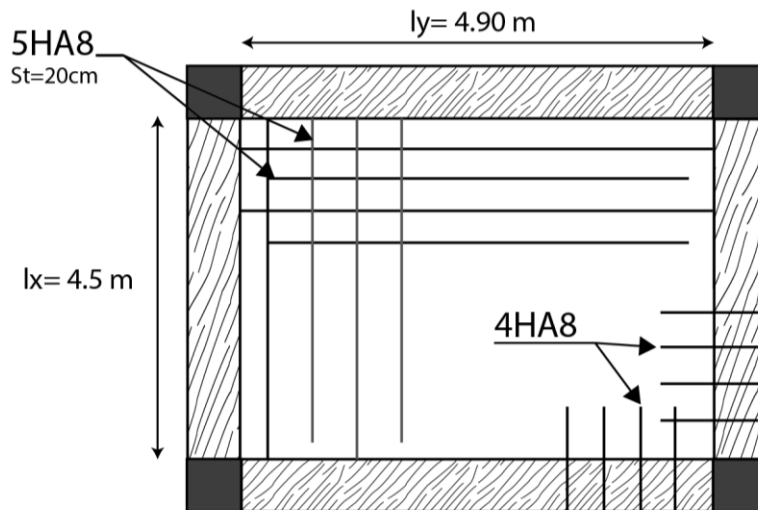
Schéma de ferrailage de la dalle sur 4 appuis.
